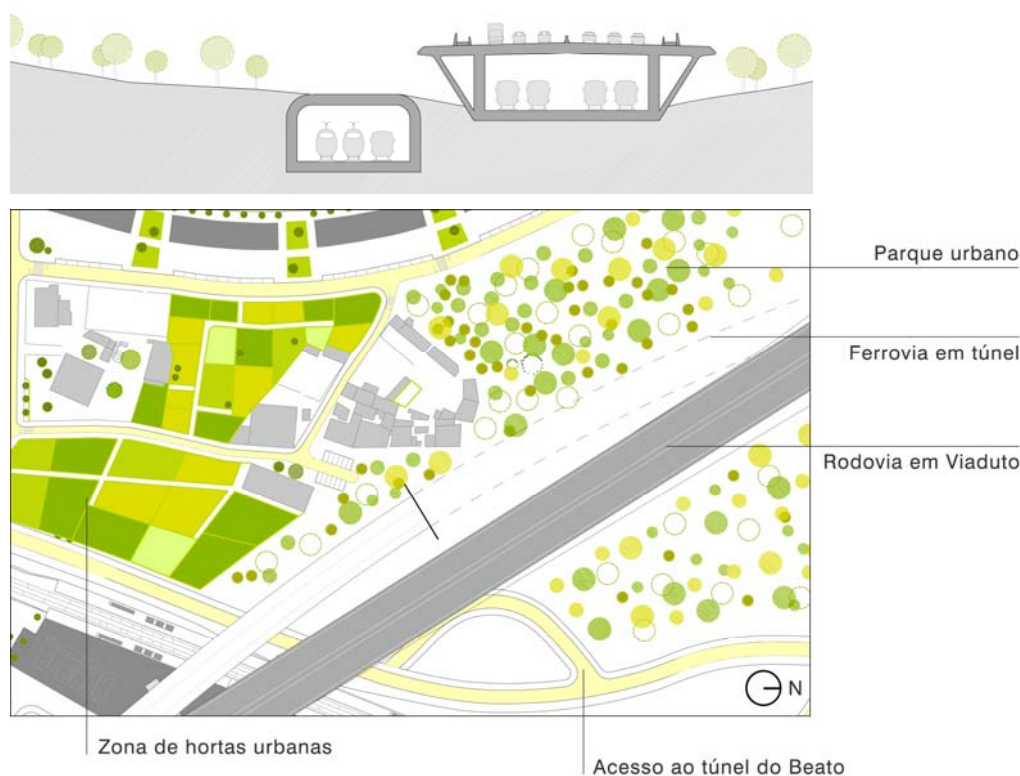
Corte e planta de inserção das infra-estruturas da ponte, acima da linha de comboio
